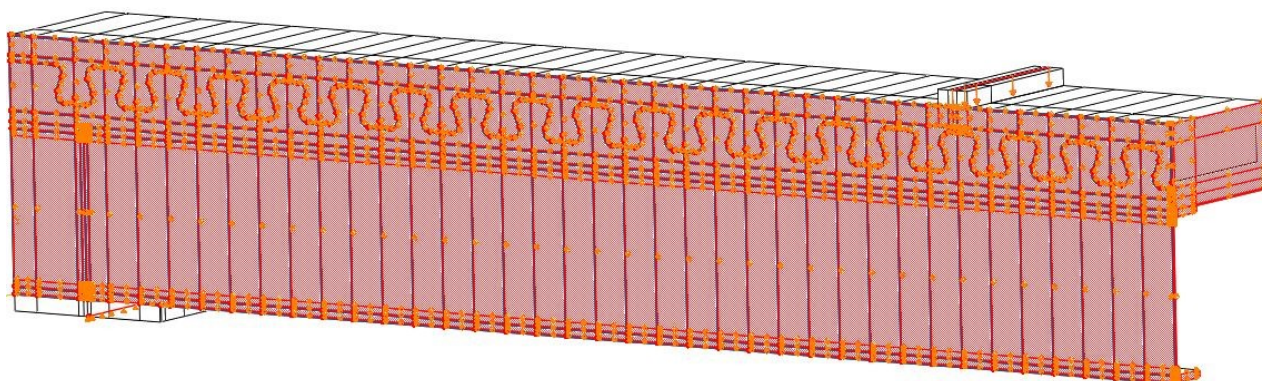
Planos de simetria, região de apoio, e aplicação do carregamento.
